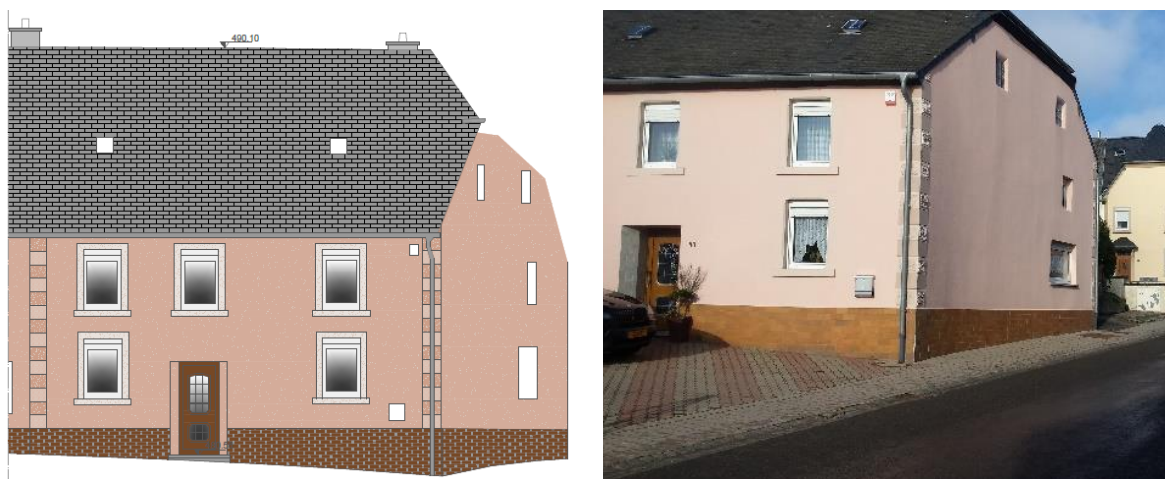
Maison existante classée « construction à conserver » (Source : BEST)
